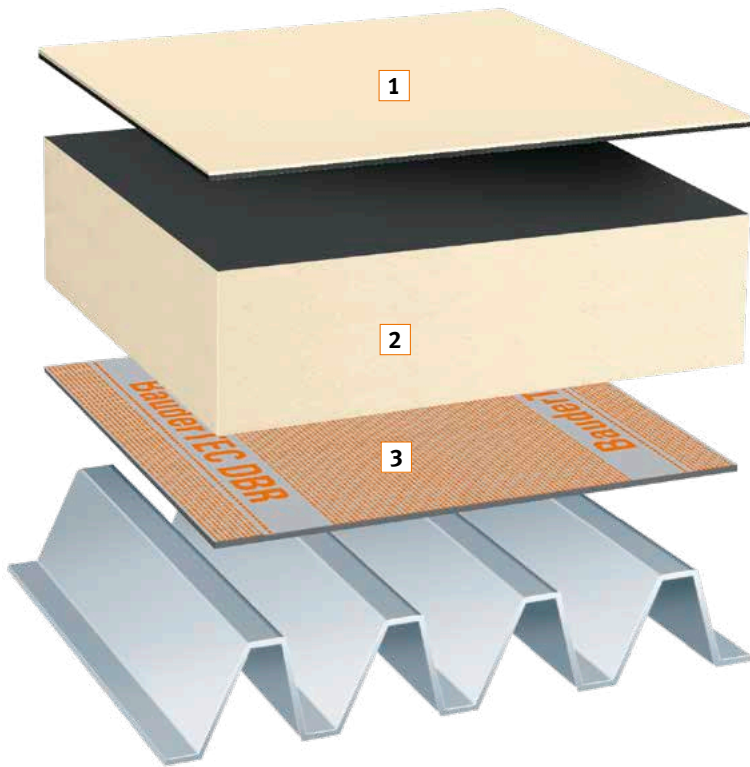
/2: Einlagiges FPO-Abdichtungssystem, mechanisch befestigt auf Trapezblech-Unterkonstruktion (z.B. Industrie-Leichtdach nach DIN 18234):
